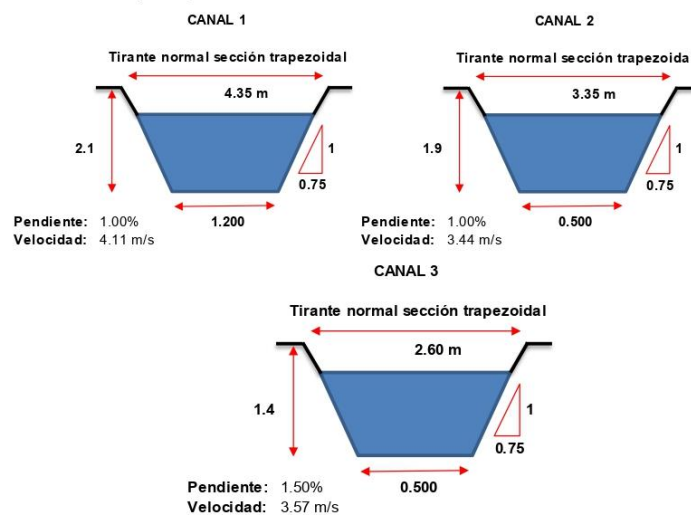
Secciones transversales de los canales de geometría trapezoidal
